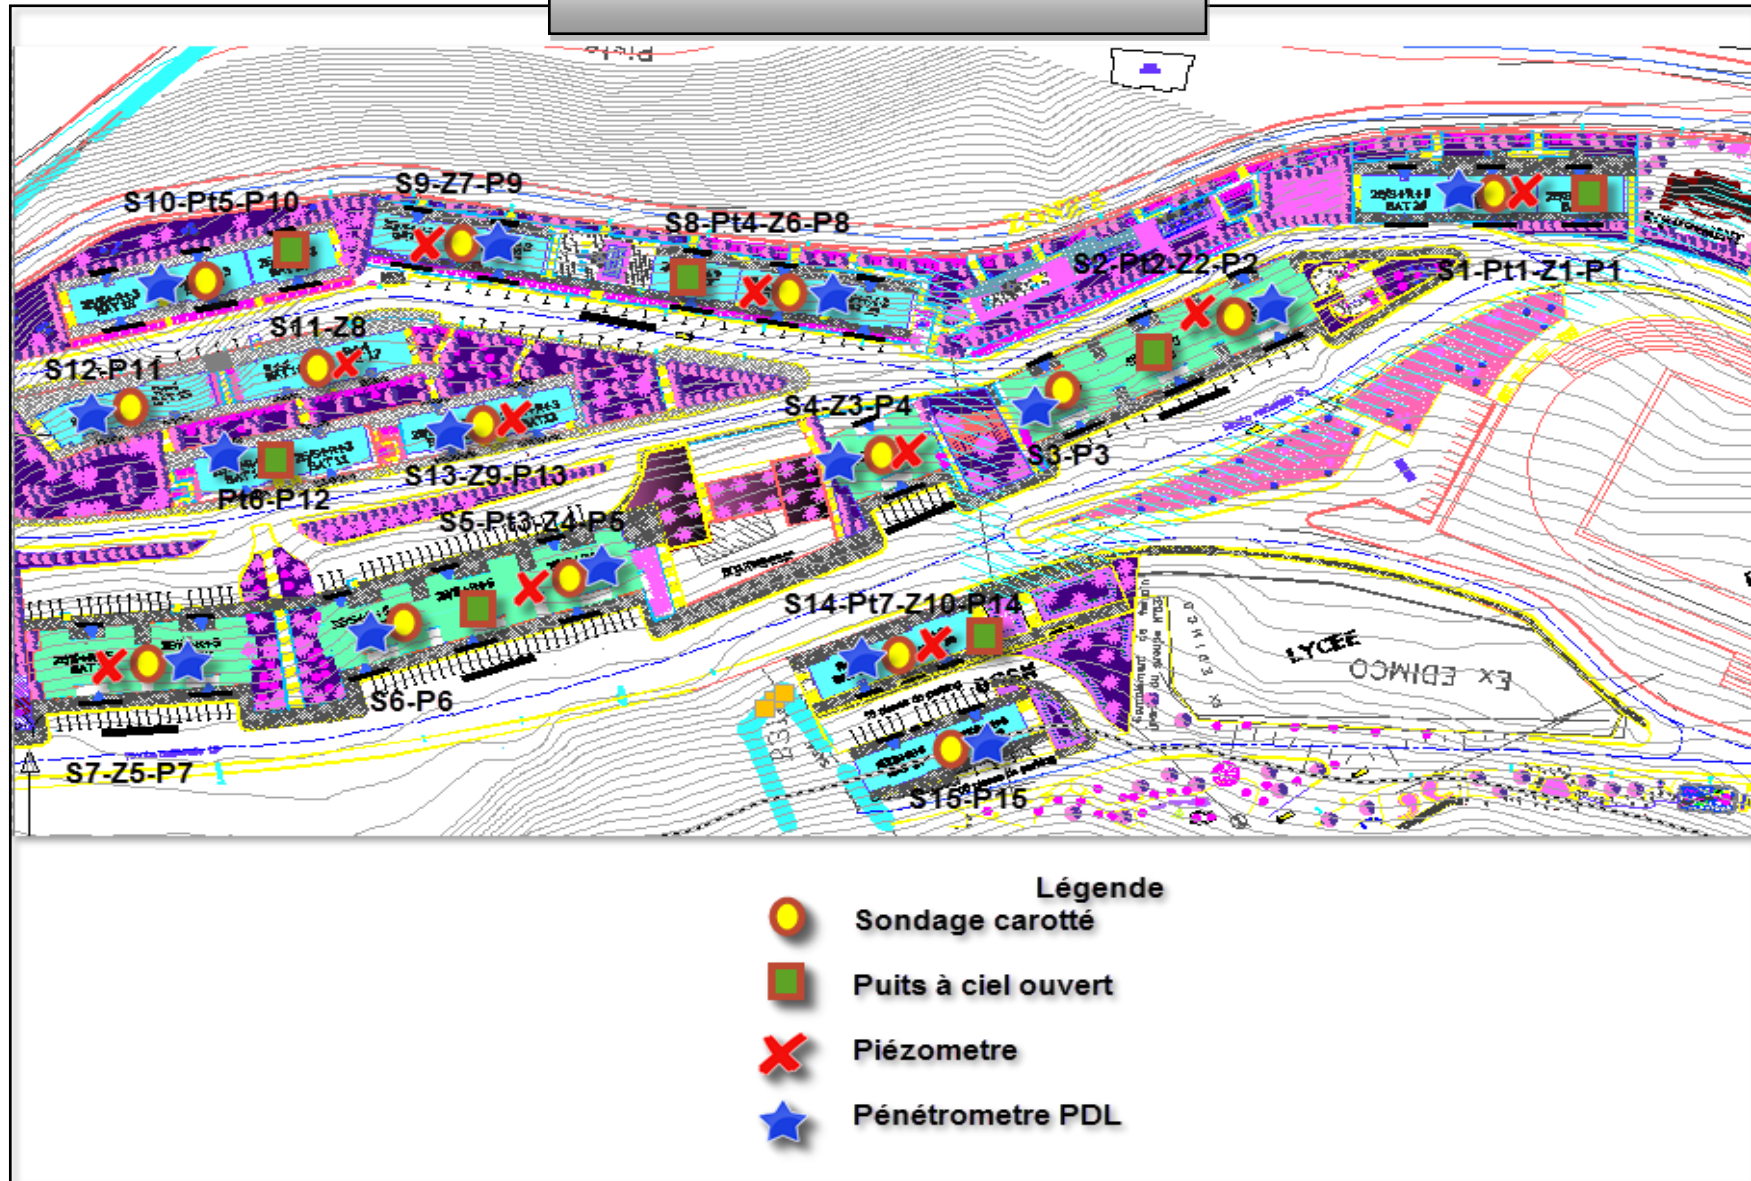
Plan d'implantation des essais in situ (Laboratoire Géo-sols, 2015)
